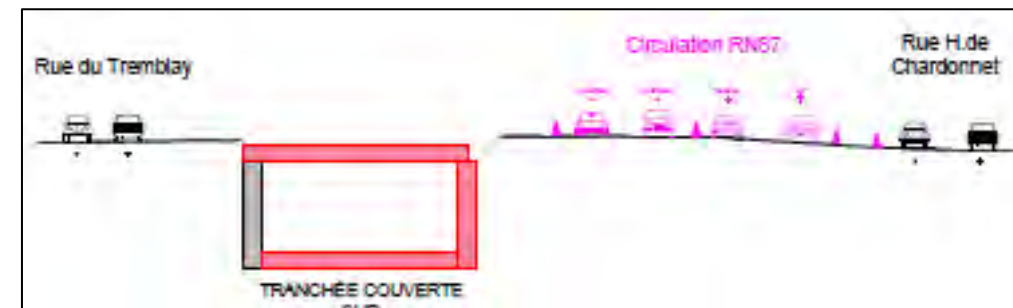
Construction du piédroit central puis du radier et de la dalle de couverture
